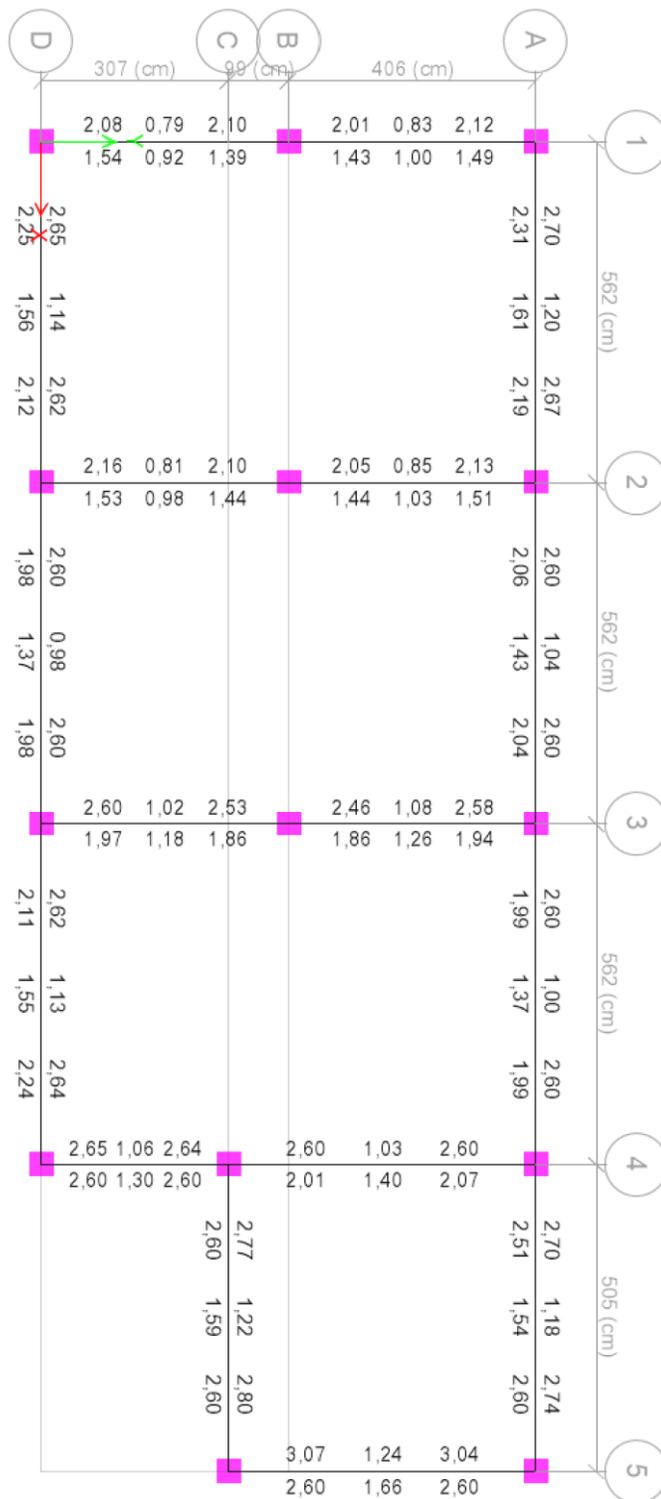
Acero requerido por vigas de amarre (en cm<sup>2</sup>)
